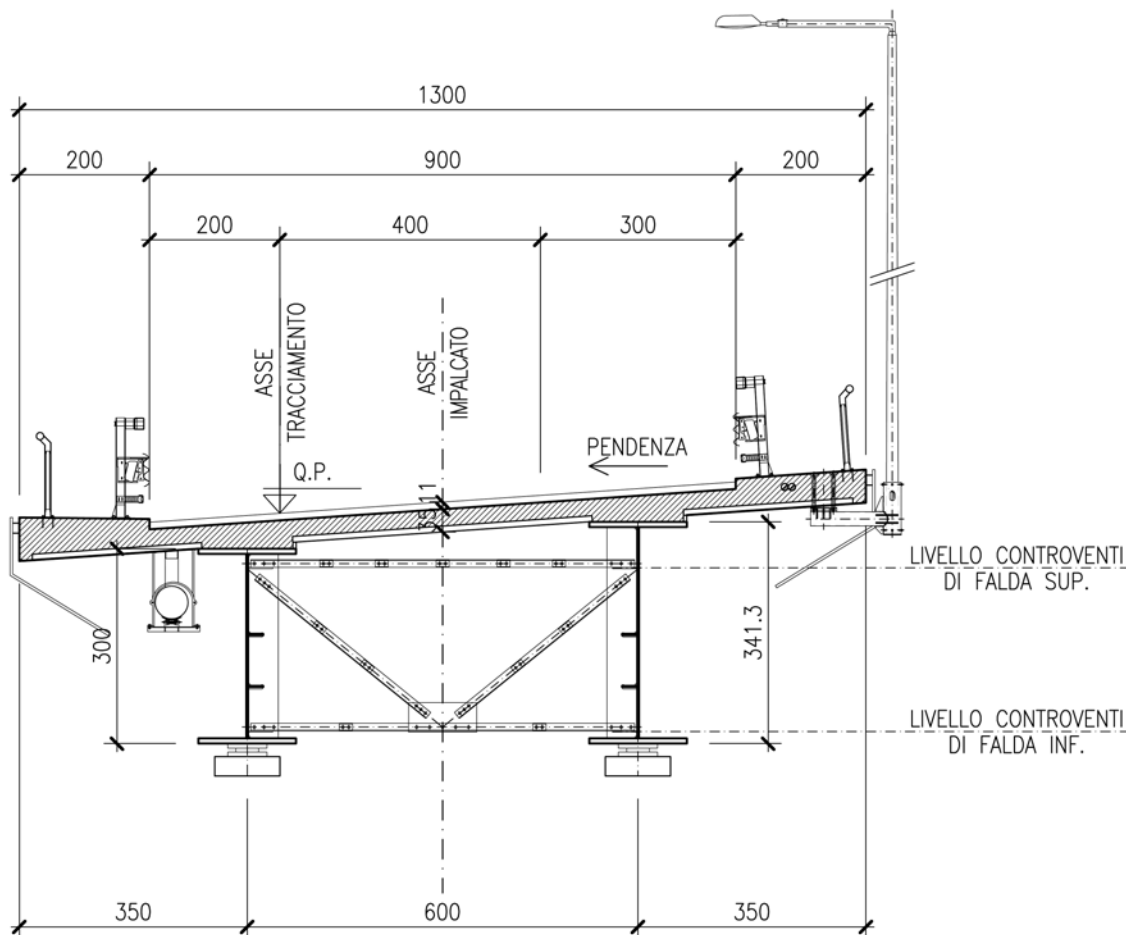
SEZIONE TRASVERSALE TIPO.
